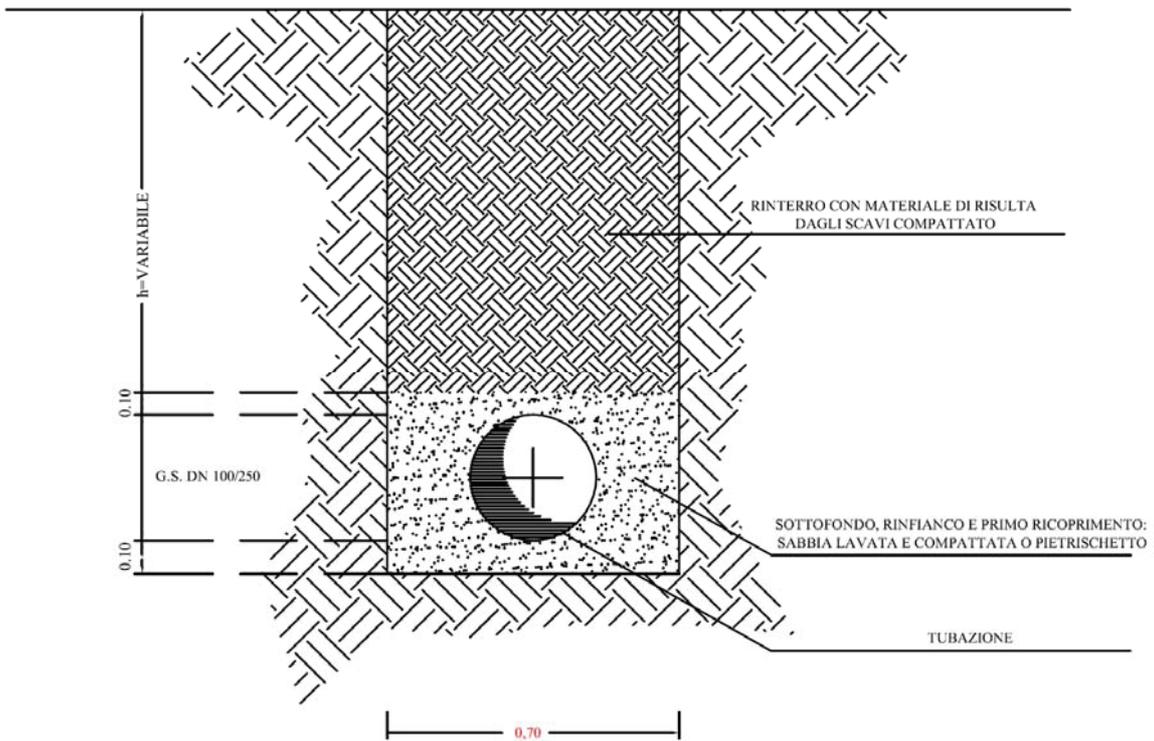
Sezione tipo di posa delle condotte in terreno nudo
